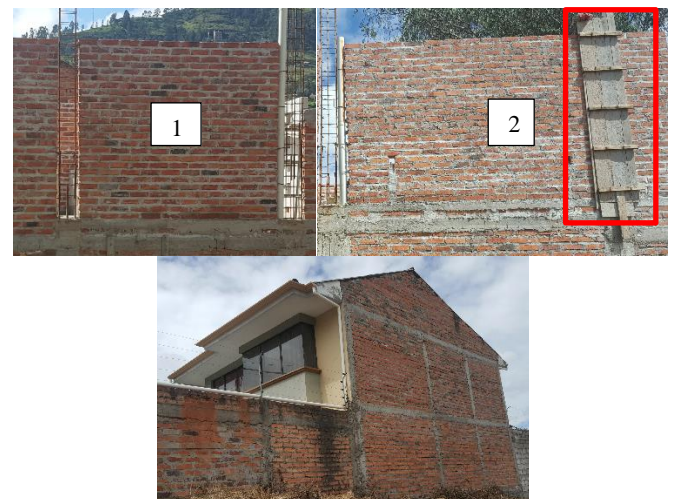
Proceso constructivo de las E-MC: 1) el panel de mampostería y 2) las columnas y vigas de confinamiento
